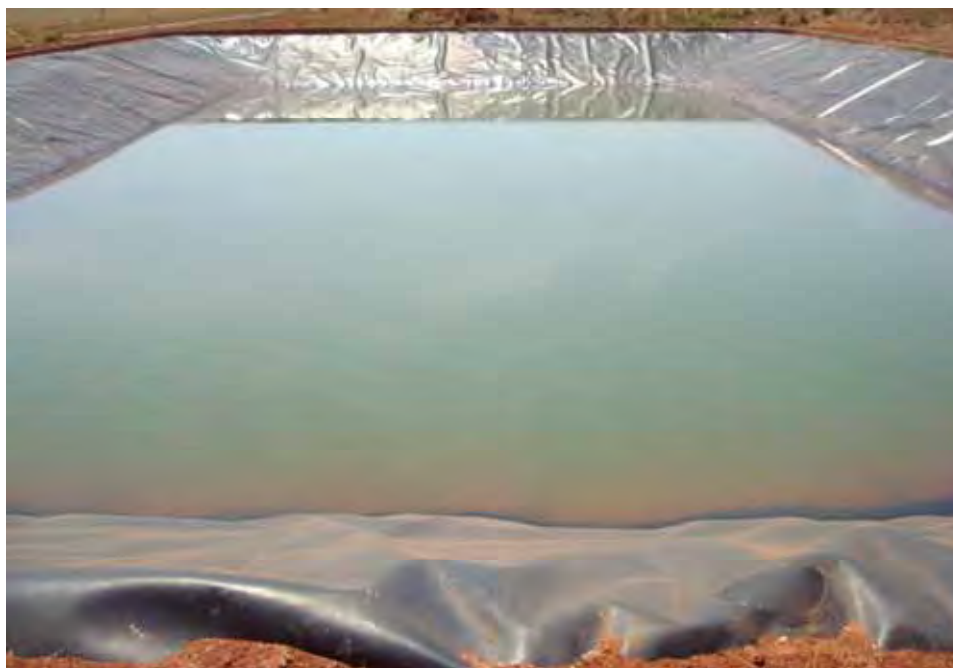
Lagoa impermeabilizada para armazenagem de manipueira
